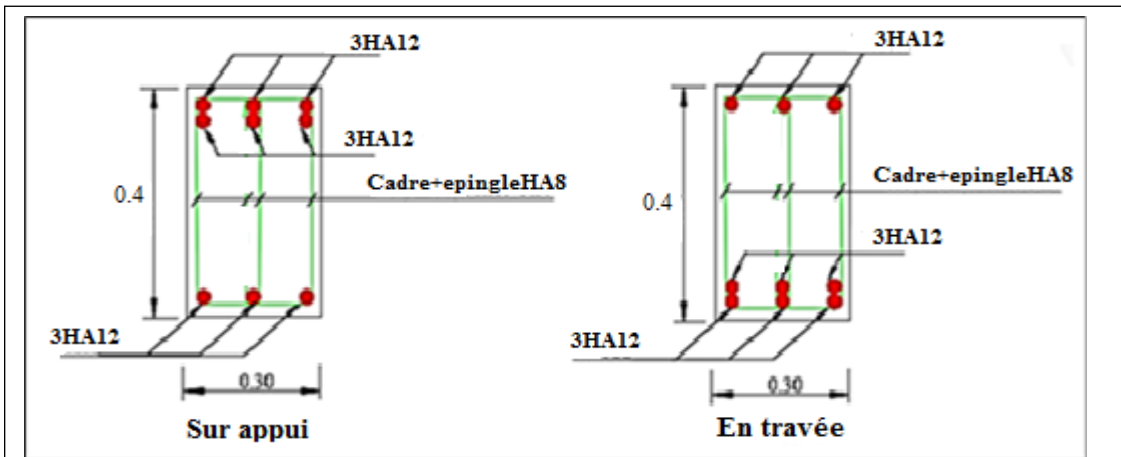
Schéma de ferrailage des poutres principales.
